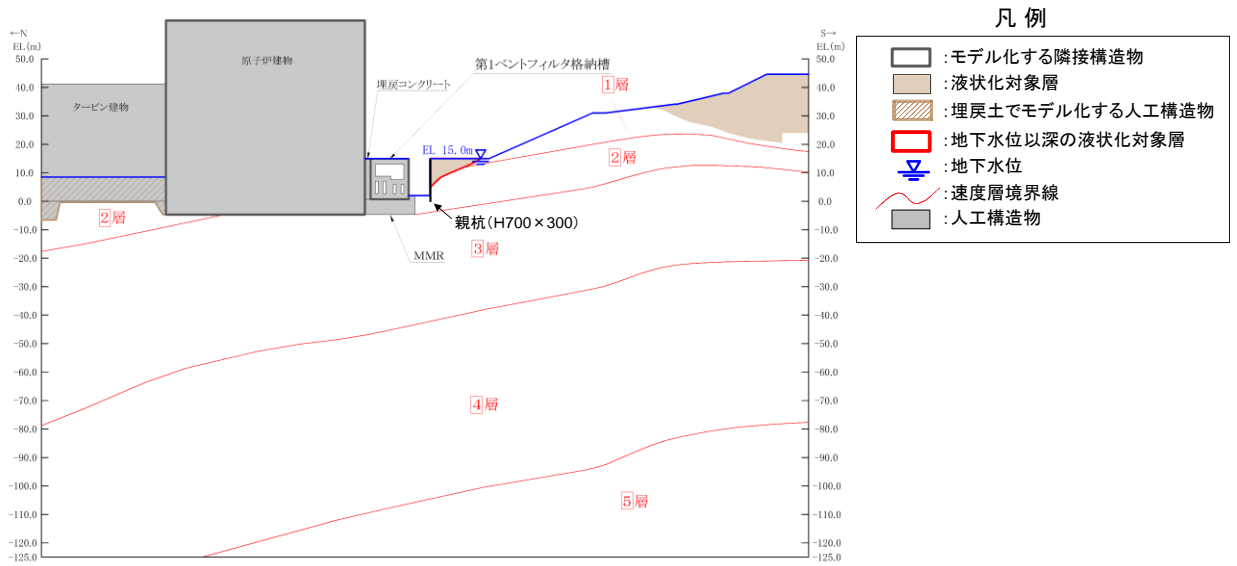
土留め工 (親杭) 検討対象断面図 (⑥-⑥' 断面)
